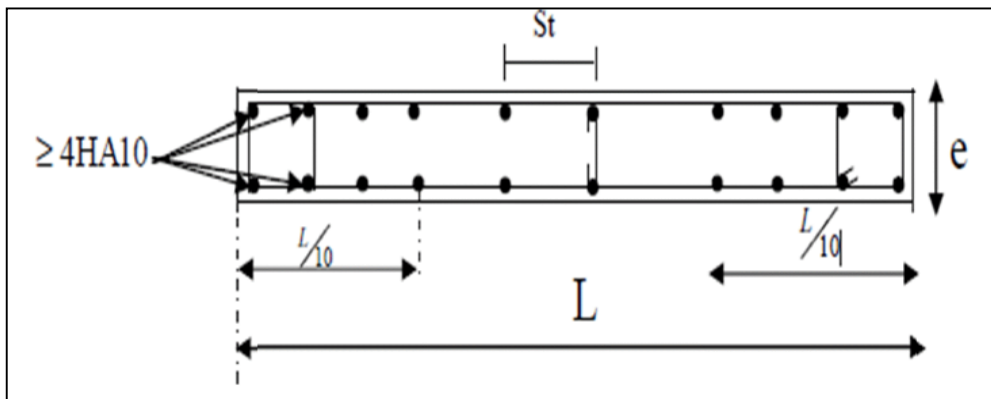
Disposition des armatures verticales dans les voiles.
